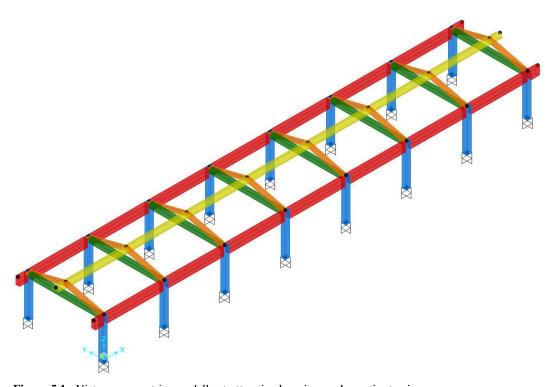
Vista assonometrica modello struttura in elevazione - elementi estrusi
